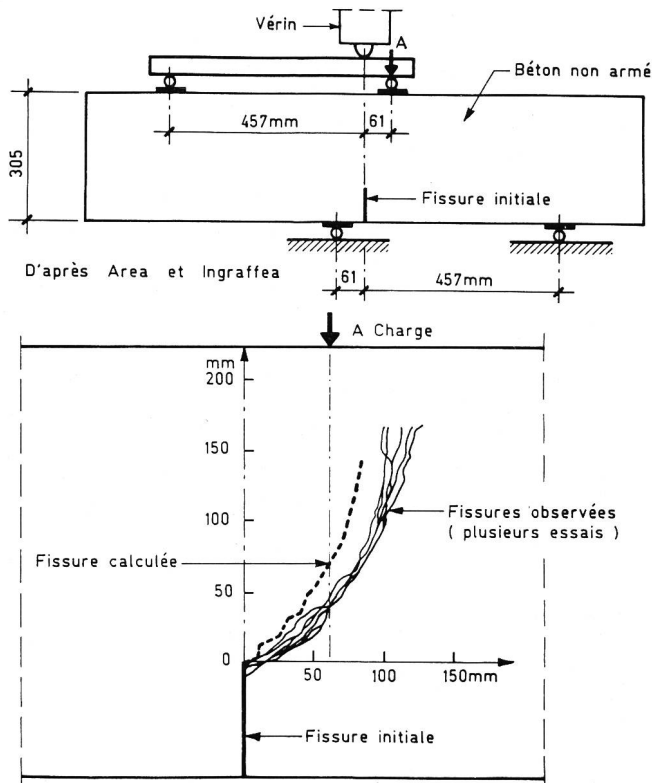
Propagation d'une fissure, essais et calcul. Dispositif d'essai et trajectoire des fissures.
